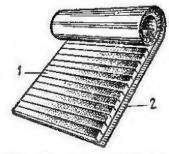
Минераловатный вертикально-слоистый мат: 1— минераловатные полосы, иматезащитио-покровный мате-
